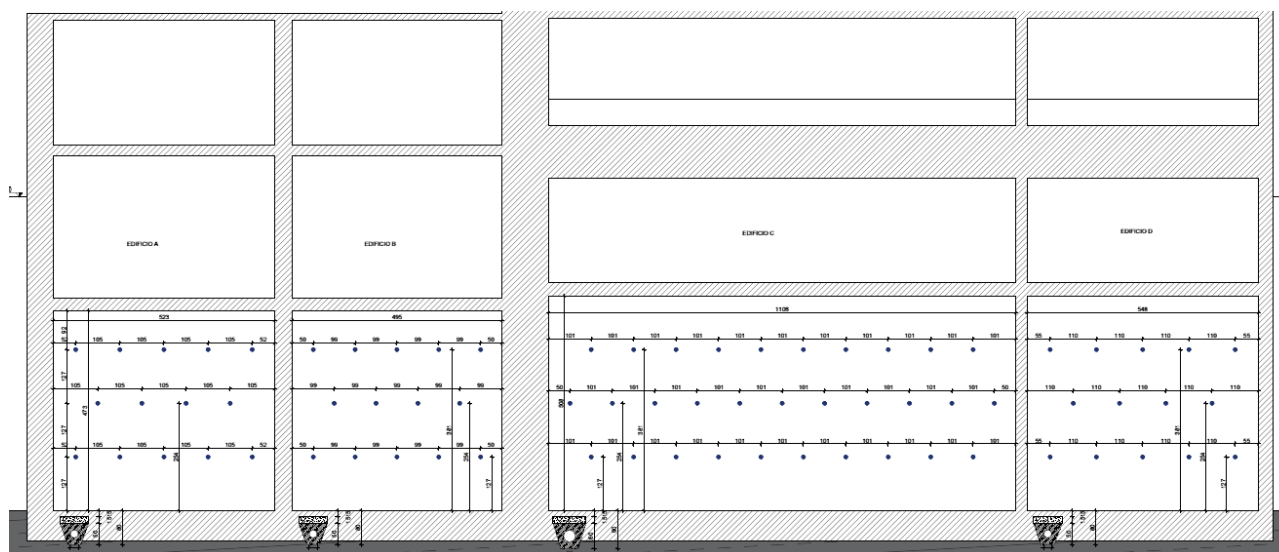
Stralcio del prospetto dei drenaggi del progetto esecutivo primo lotto
